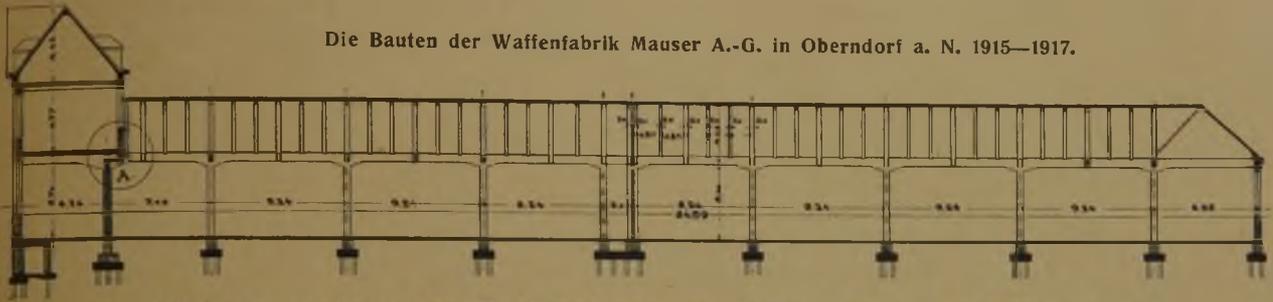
Querschnitt des Werkstättenbaues D mit Anbau Z. (Vgl. Plan Abb. 1.)
